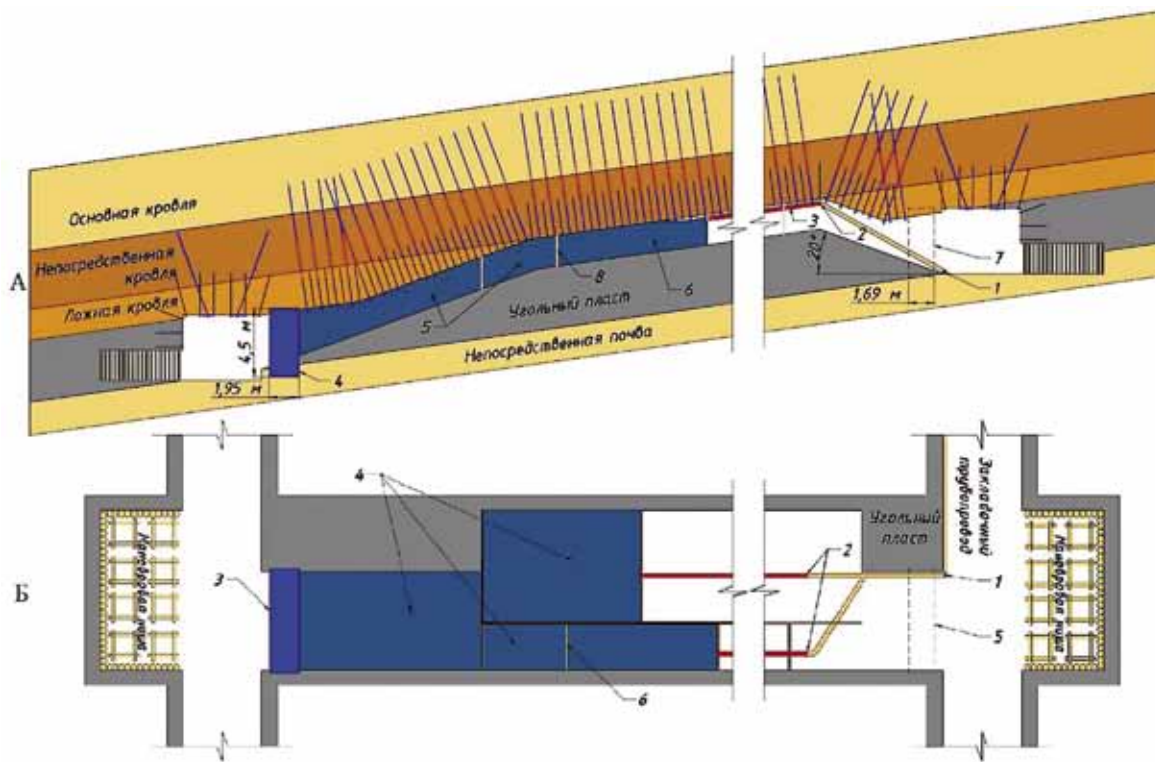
Схема предлагаемого способа возведения искусственного перекрытия: А – продольный разрез; Б – вид сверху; 1 – клапан аварийного сброса смеси; 2 – места соединения металлического и полиэтиленового трубопроводов; 3 – изолирующая перемычка; 4 – блоки закладочного массива; 5 – место возведения изолирующей перемычки; 6 – межблоковая опалубка
